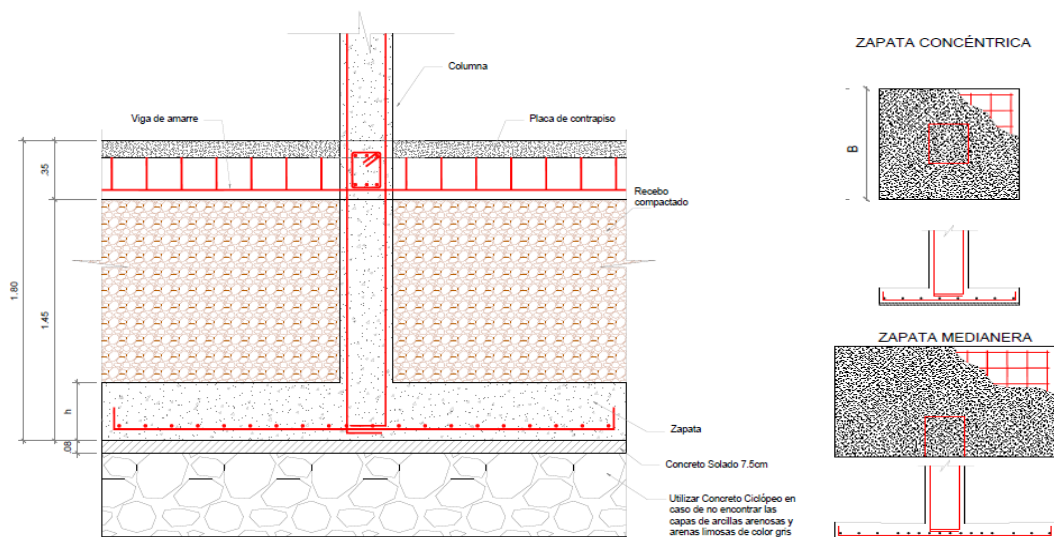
Detalle de Cimentación y Especificación de Zapatas; Fuente: Oficina de Planeación Universidad de Pamplona (2019).
